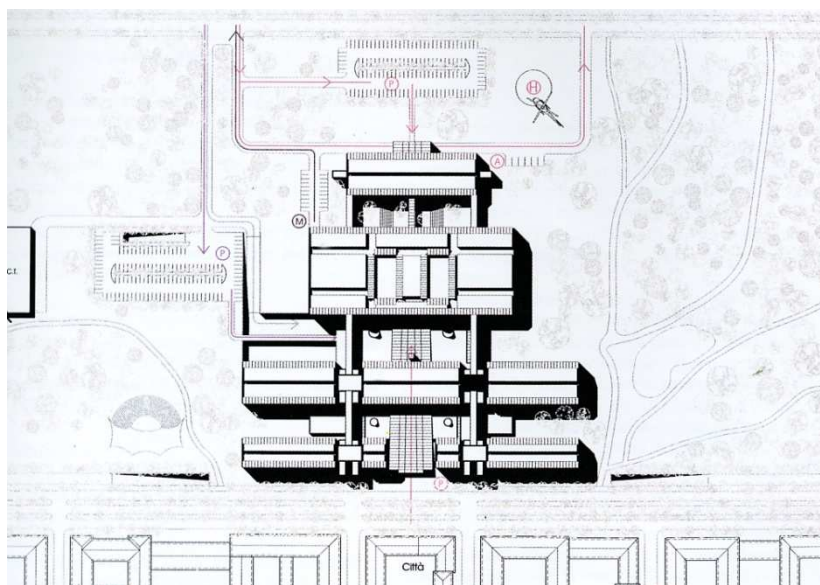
planimetria ideale del Metaprogetto Piano-Veronesi con accessi principali.
